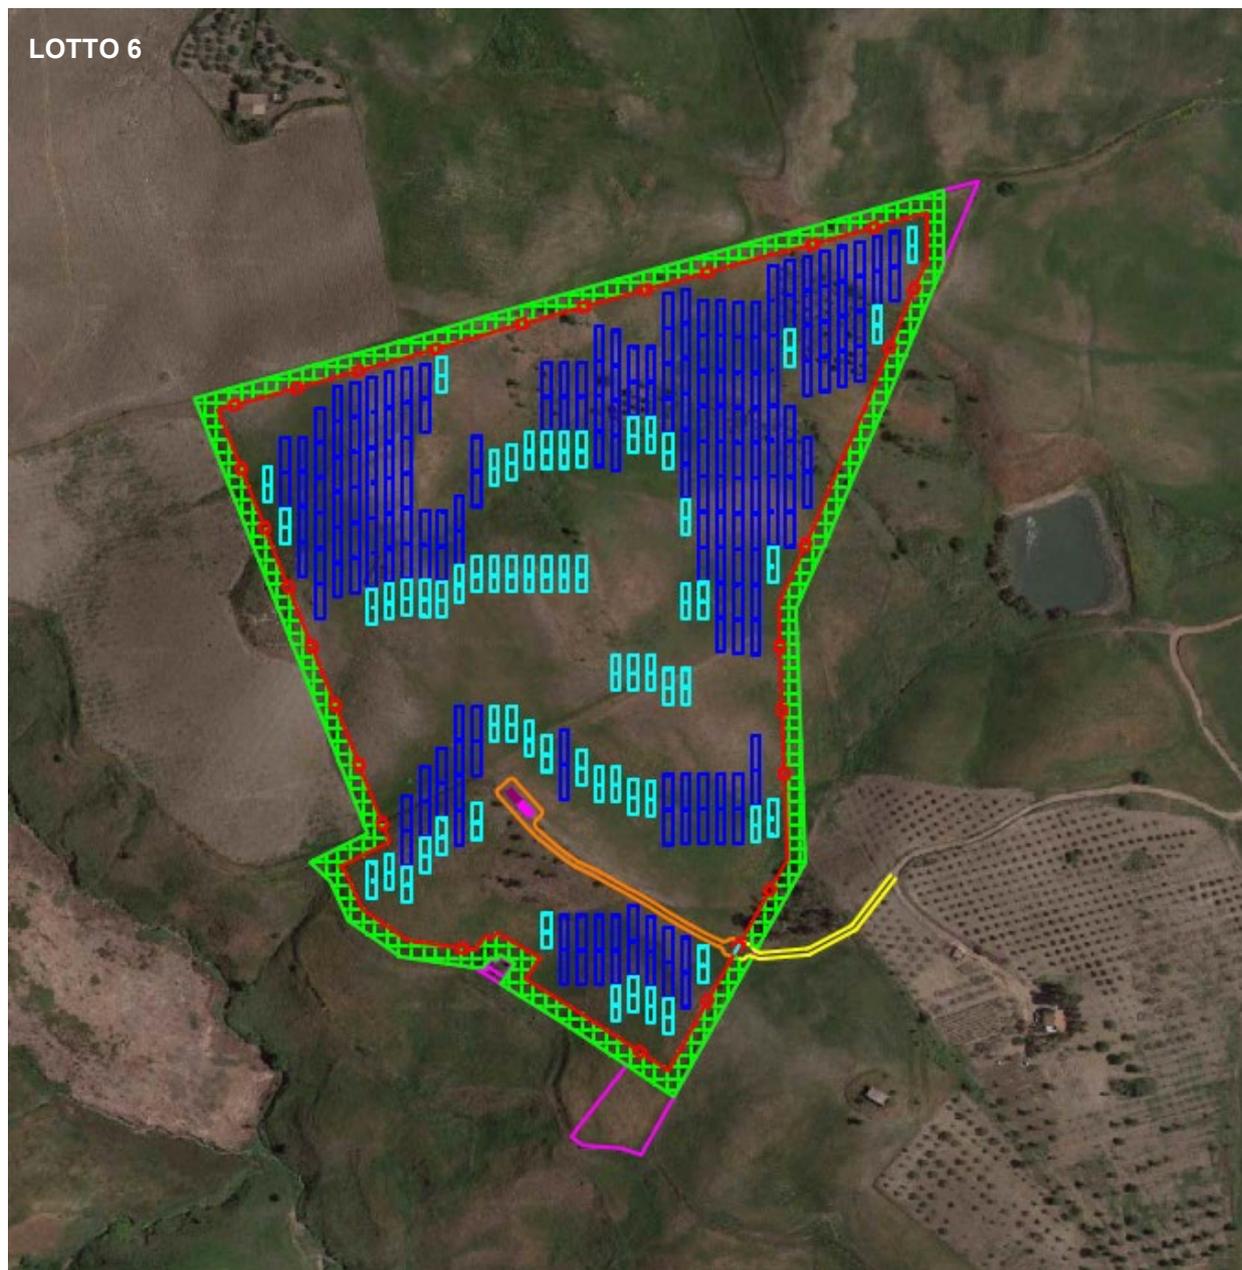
Sovrapposizione su ortofoto del layout di impianto (5 foto, 6 lotti).
